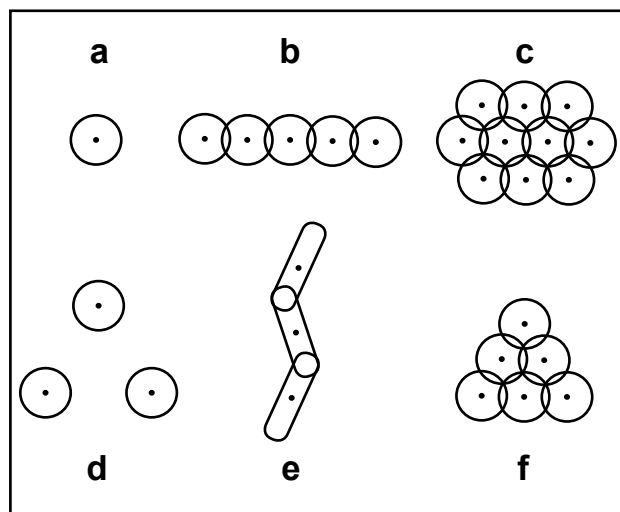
Arranjos típicos de aplicações de Jet Grouting.
